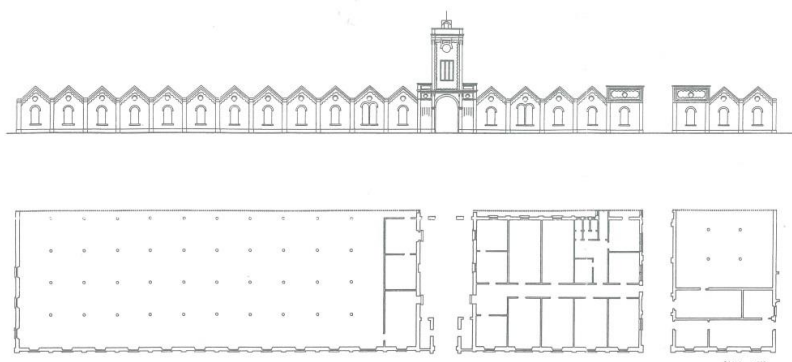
Prospetto e pianta del cotonificio Amman & Wepfer a Pordenone.
